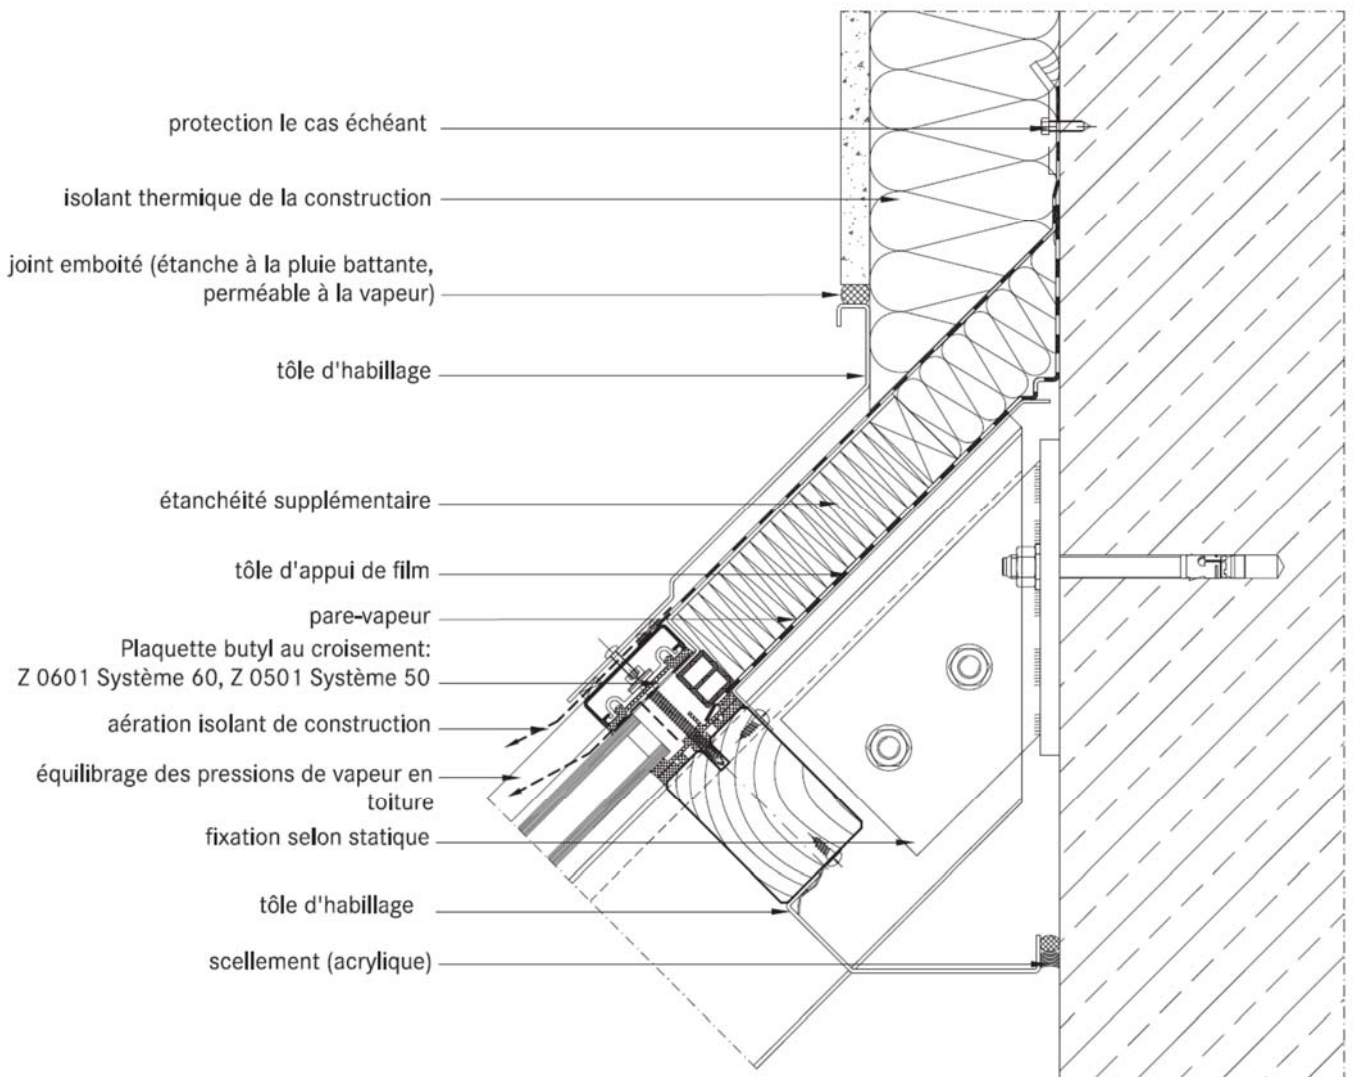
Système H, détail de construction système STABALUX bois, vissage direct
